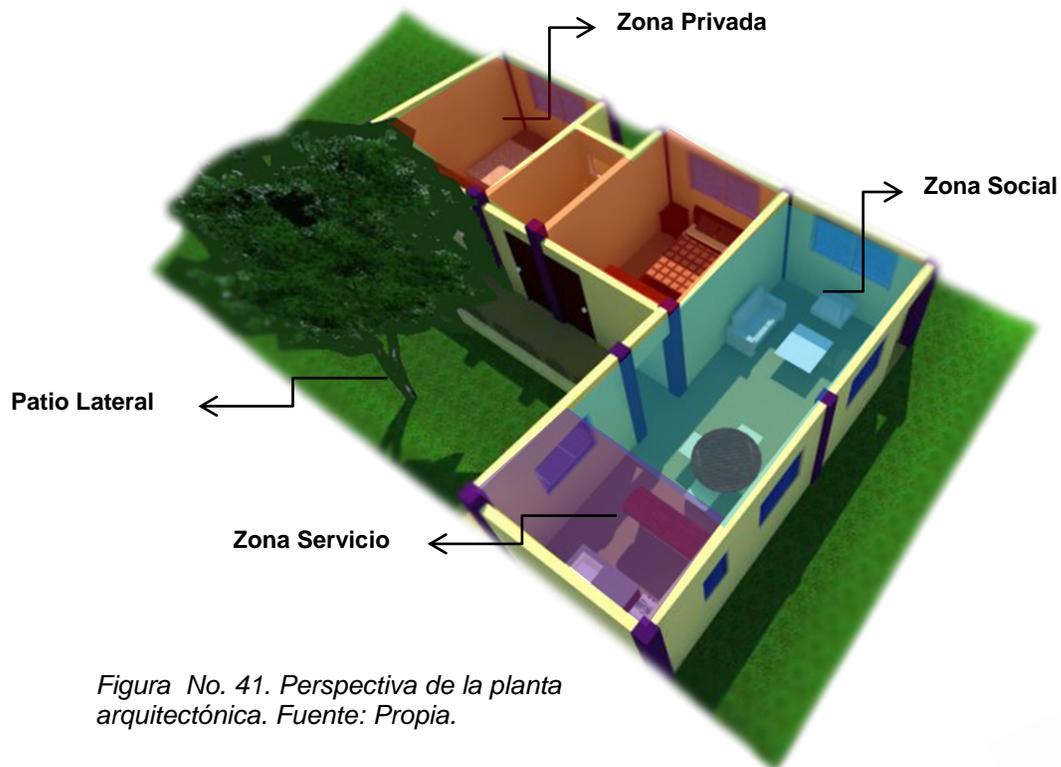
Perspectiva de la planta arquitectónica. Fuente: Propia.
